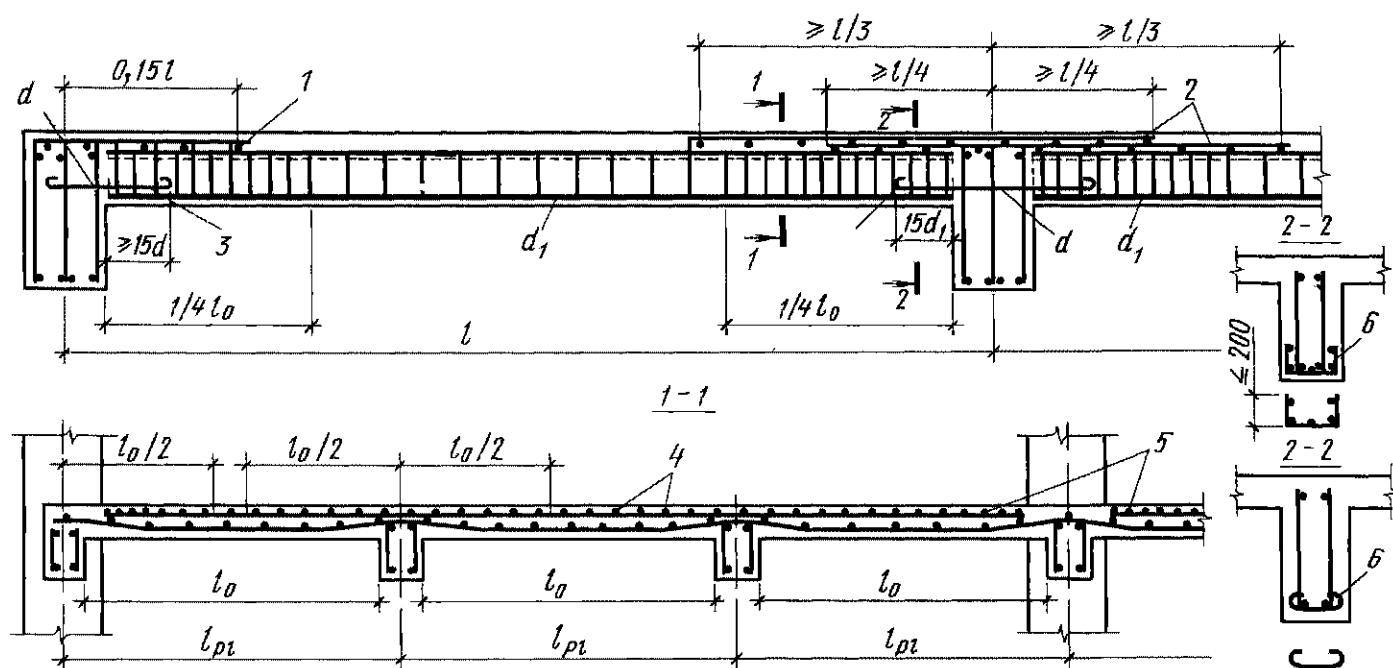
Армирование второстепенной балки сварными плоскими каркасами и сетками
